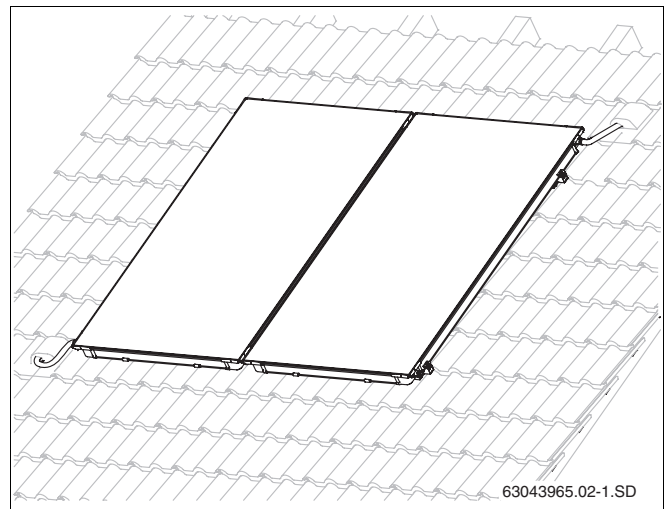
Vista general de dos colectores, montaje sobre el tejado
